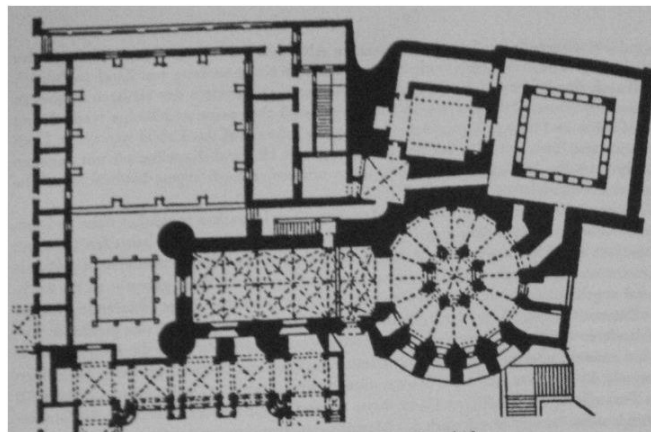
Grundriss der Templerkirche von Tomar, 1180-1250.
